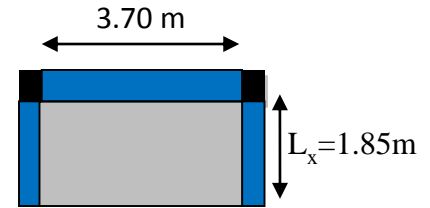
dalle pleine sur 3 appuis type 2.
